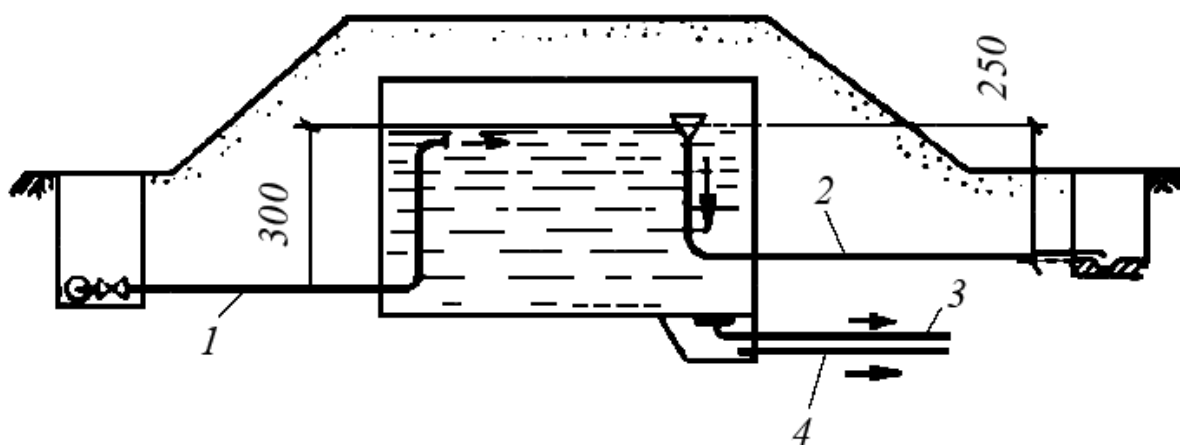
Схема оборудования трубопроводами резервуара чистой воды
